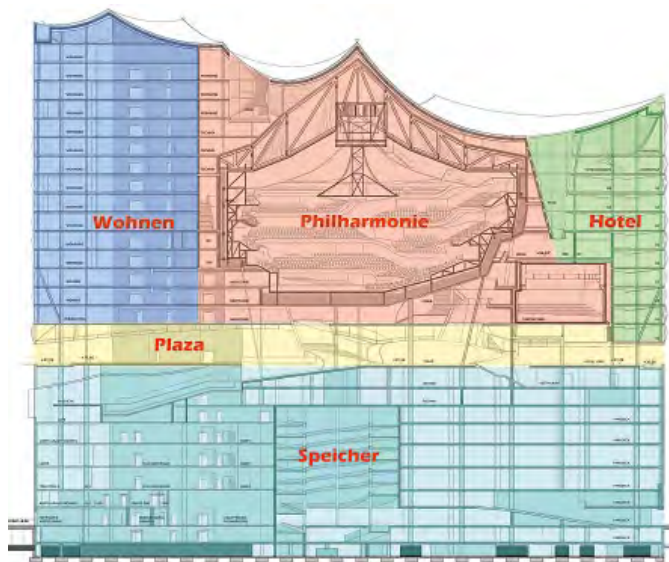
Schnitt durch das Gesamtgebäude mit Angabe der Nutzungsbereiche
